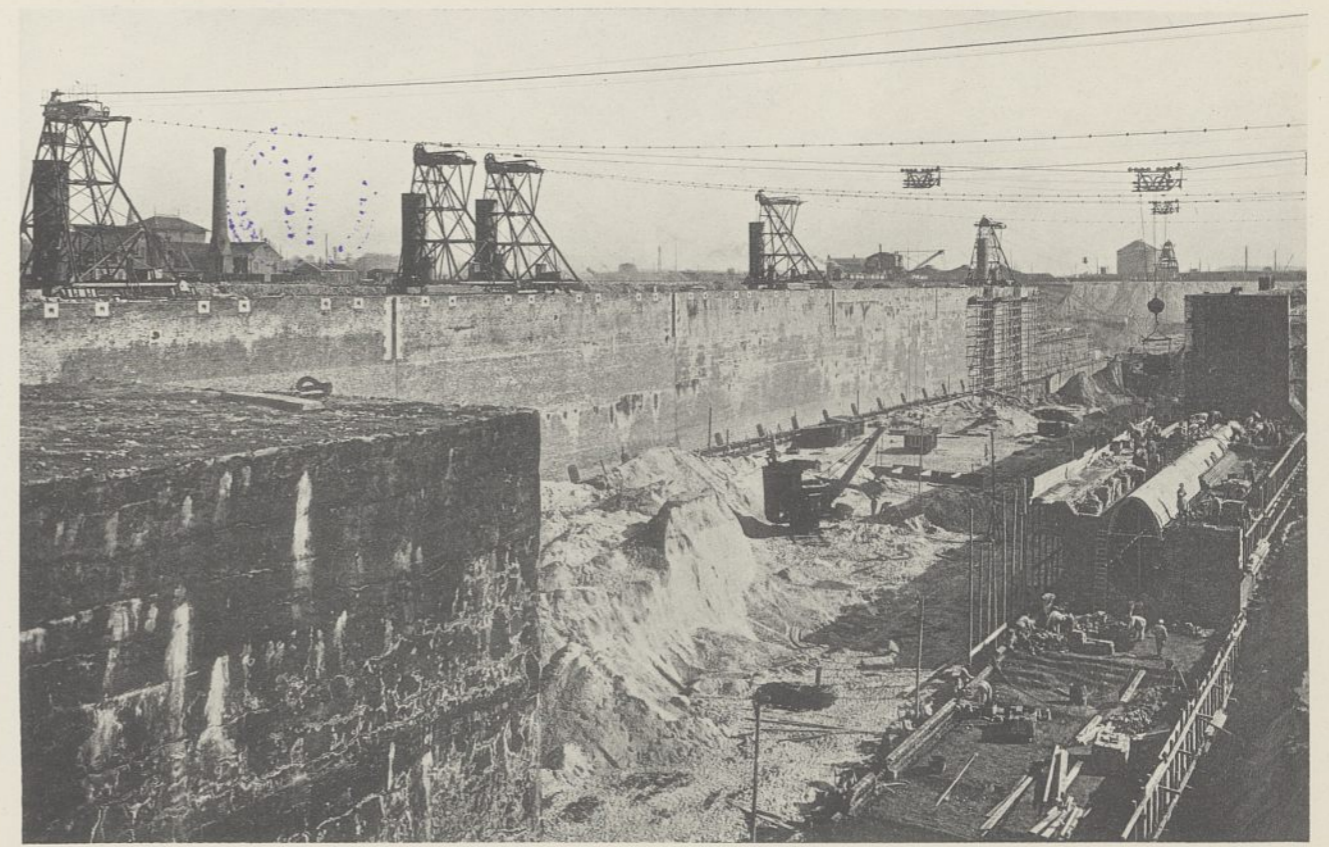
Ansicht der Baustelle im Bauabschnitt III.
